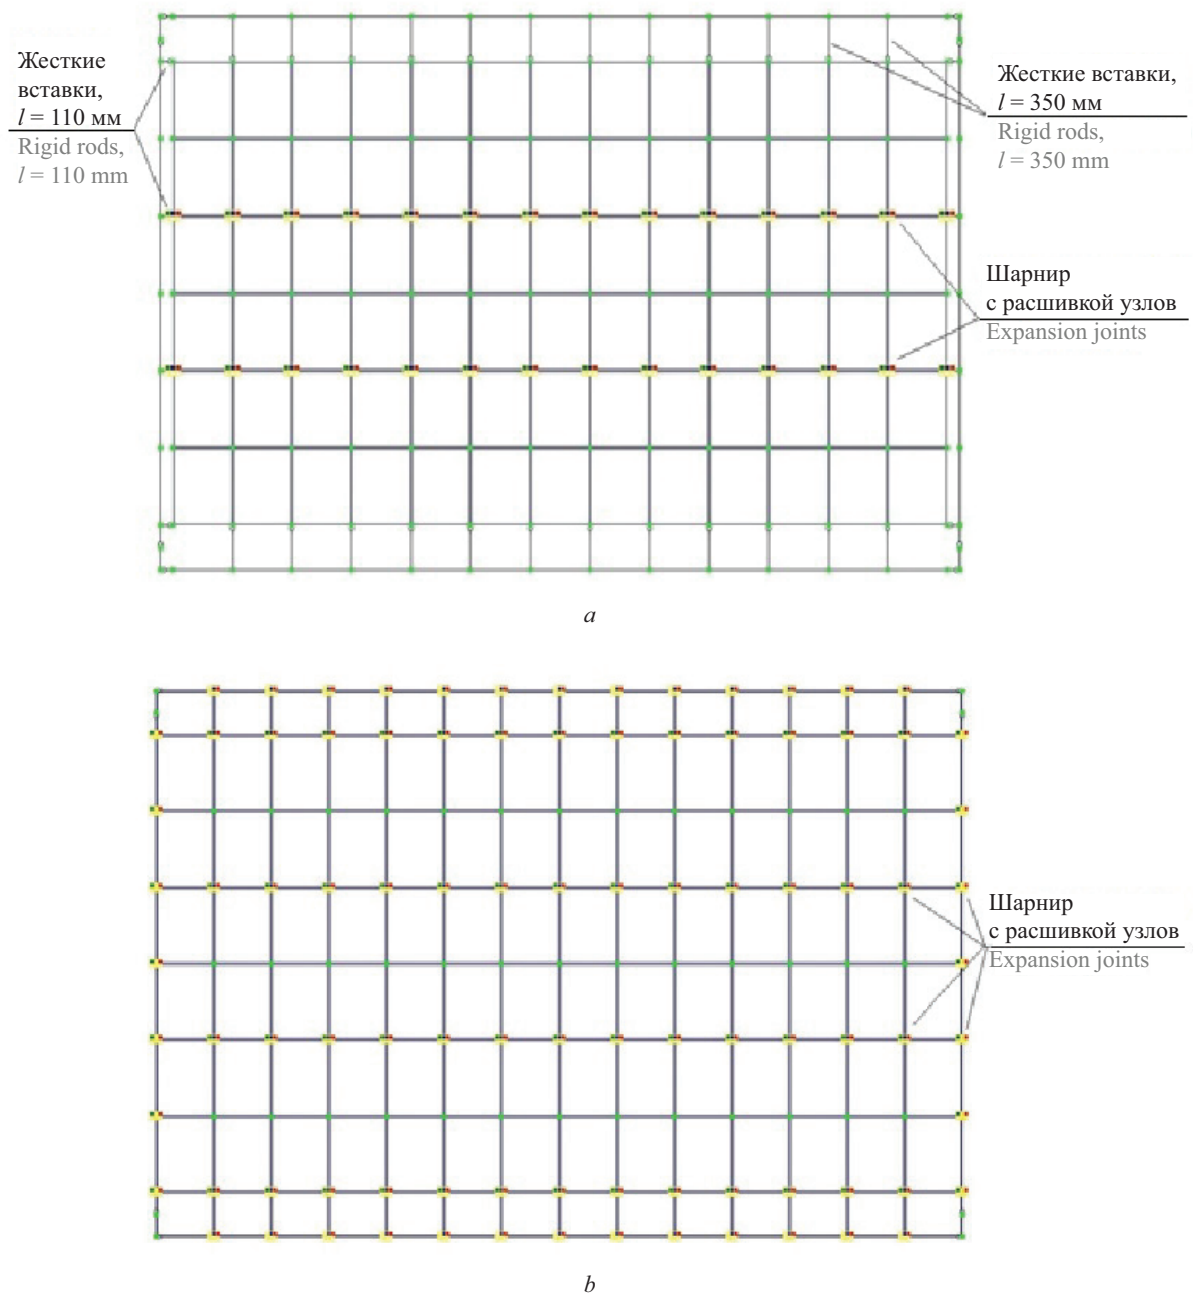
Расчетная модель перекрытия: *a* — с использованием жестких вставок; *b* — с триангуляцией контура по всей ячейке
